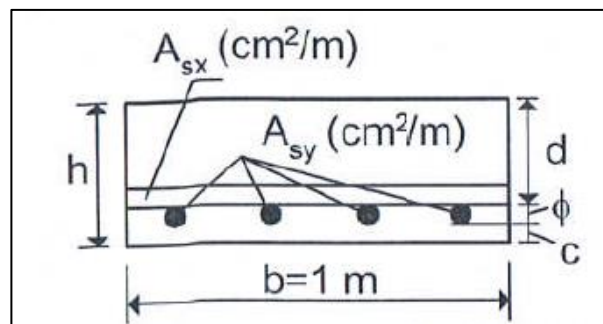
Seção transversal para o cálculo das armaduras das lajes
